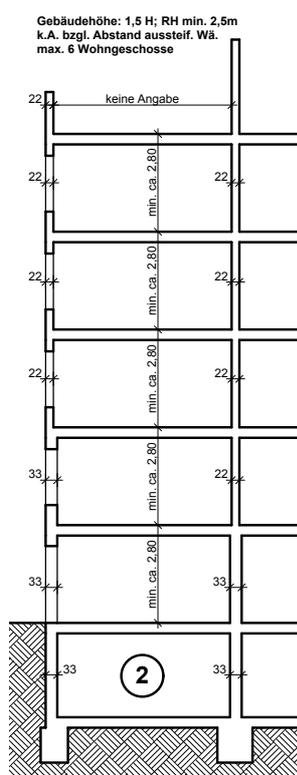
BauO HH 1918 mit Bekanntm. Bau kleiner Wohn., 1920
